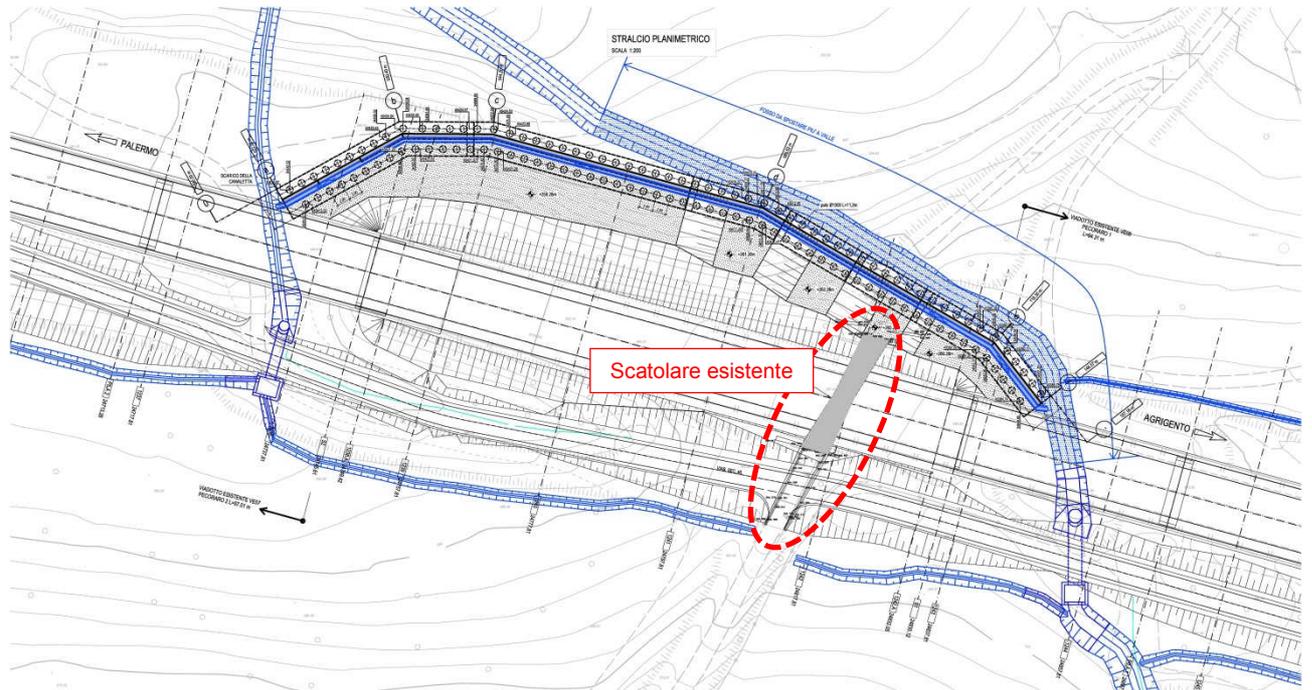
Stralcio planimetrico dell'intervento con individuazione dello scatolare esistente
